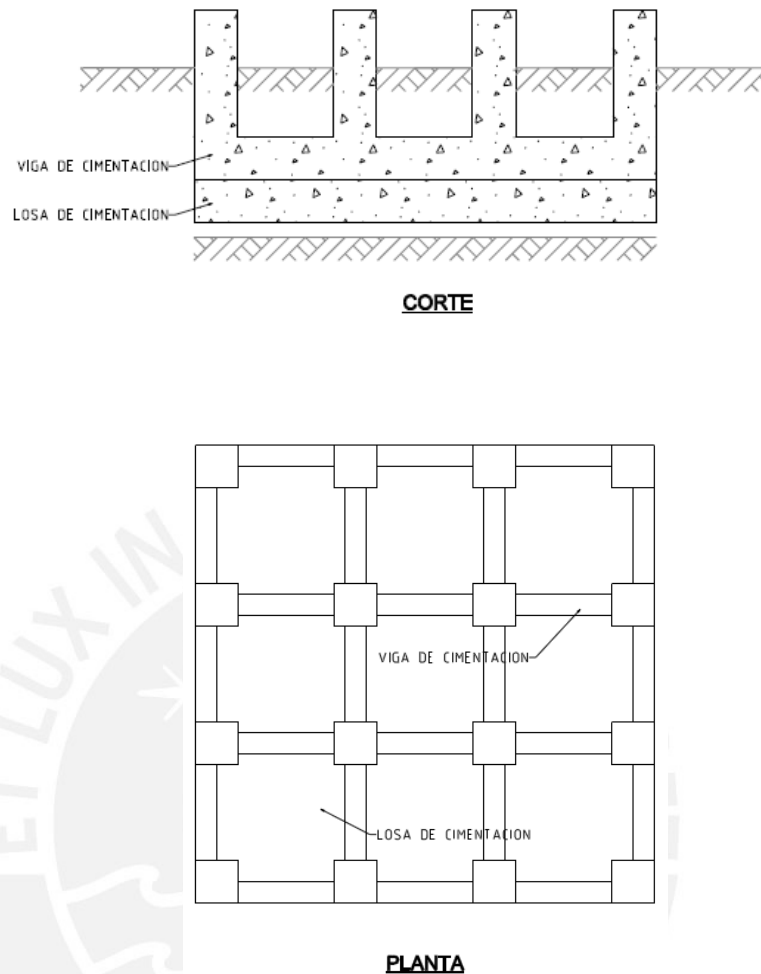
Vista en corte y planta de una losa de cimentación (Peck, 1988)
